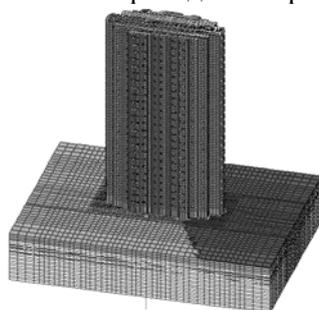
Расчётная схема 23-этажного здания по ул. Кавказской
